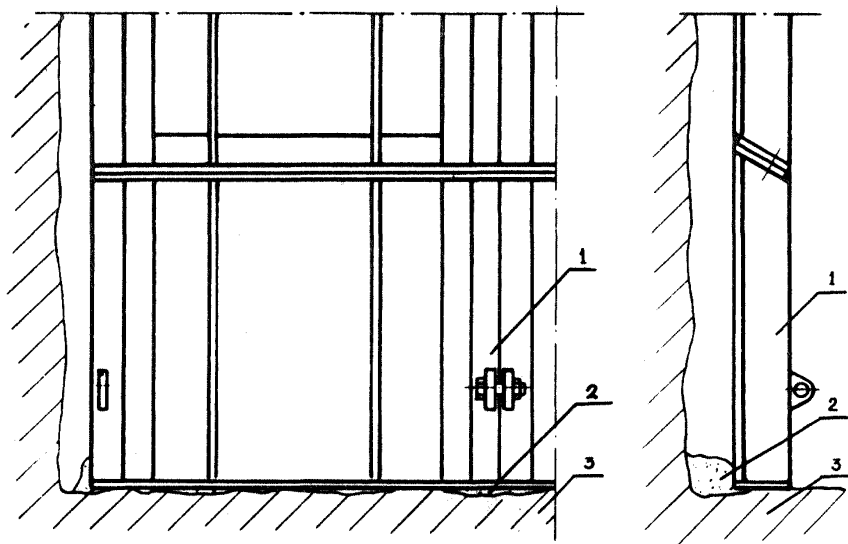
Схемы изоляции опалубки в почве выработки при помощи тампонажного раствора, закладываемого за секции опалубки;
